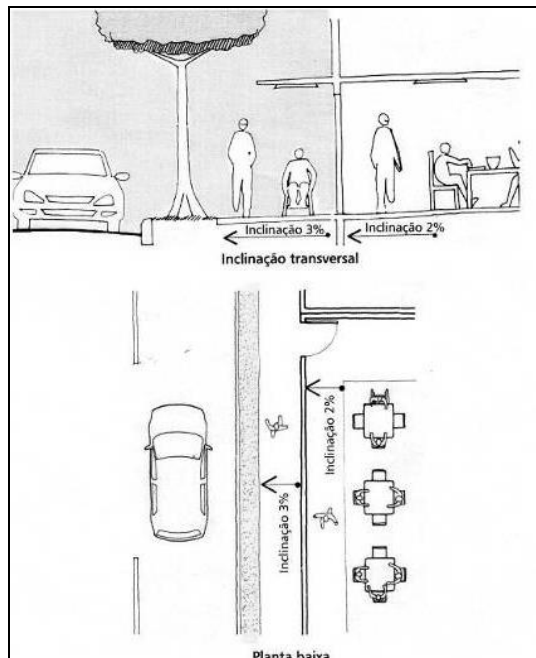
Escoamento de águas pluviais da calçada para a faixa de serviço.
